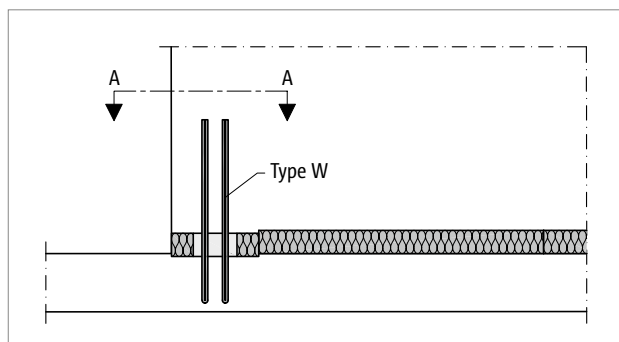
Schöck Sconnex® type W-N-VH: Vormvariant B – bijlegwapening voor aansluiting op muurkop
